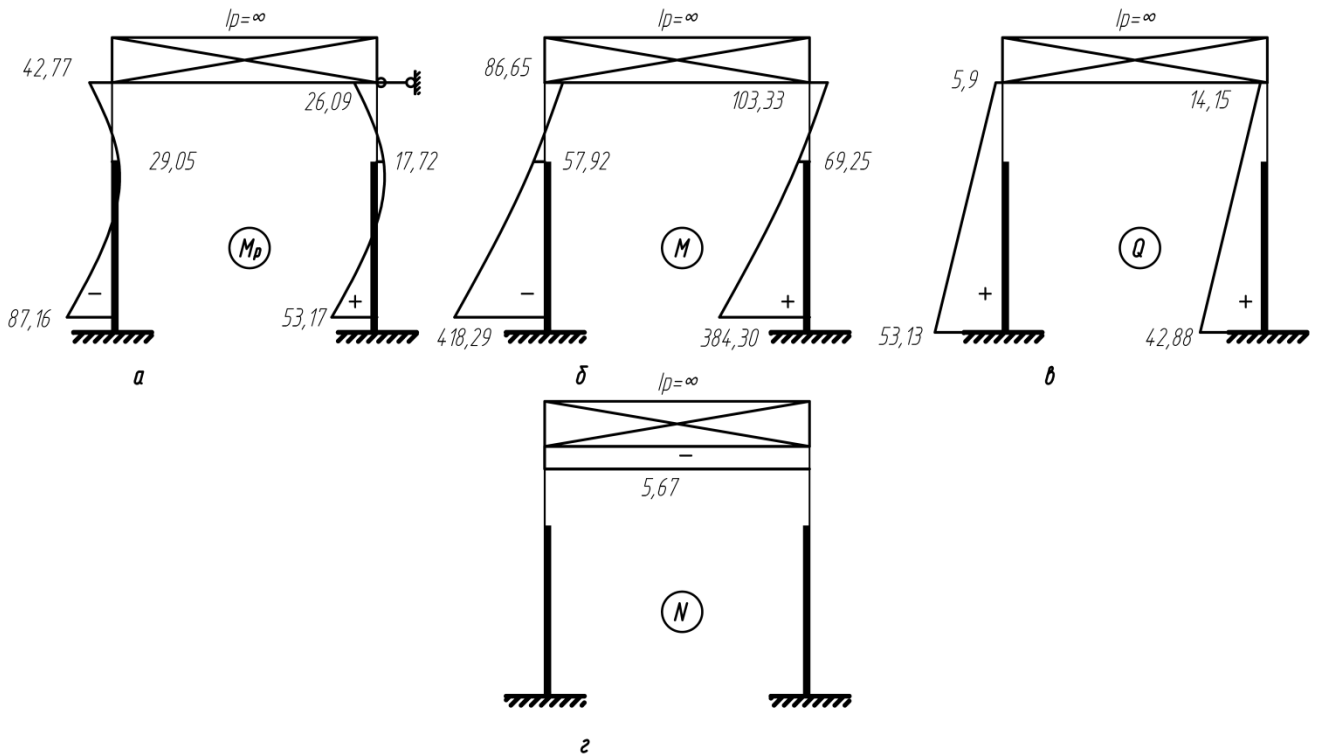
Эпюры усилий от ветровой нагрузки: а – грузовая эпюра; б, в и г – соответственно эпюры моментов, поперечных и продольных сил
